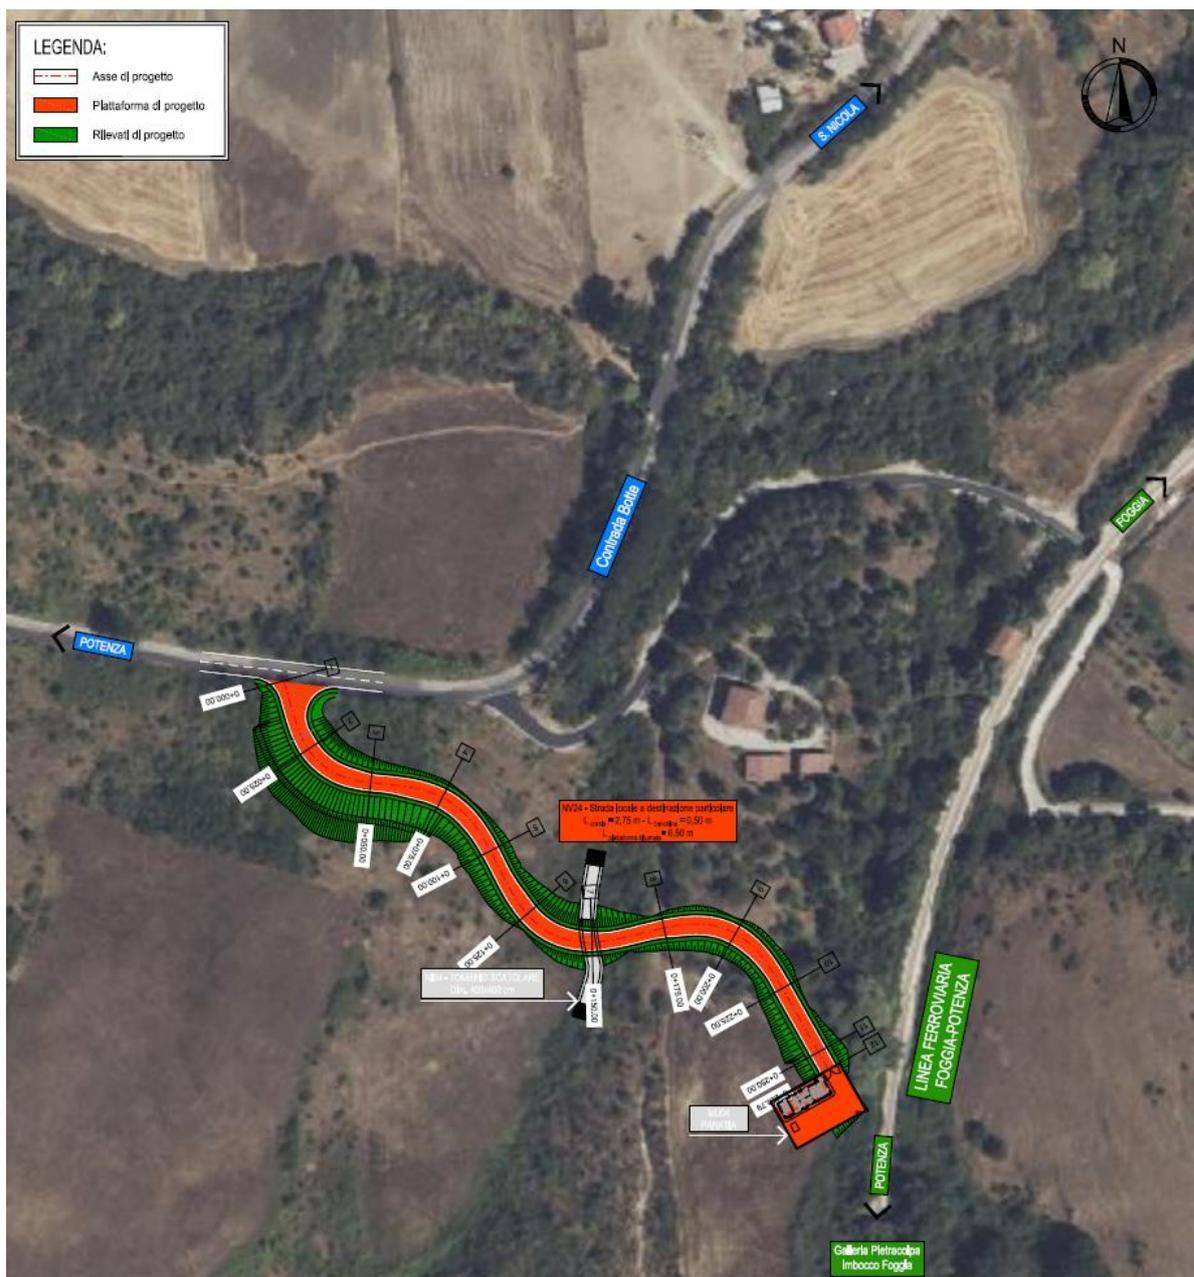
Imbocco lato Foggia galleria Pietracolpa
